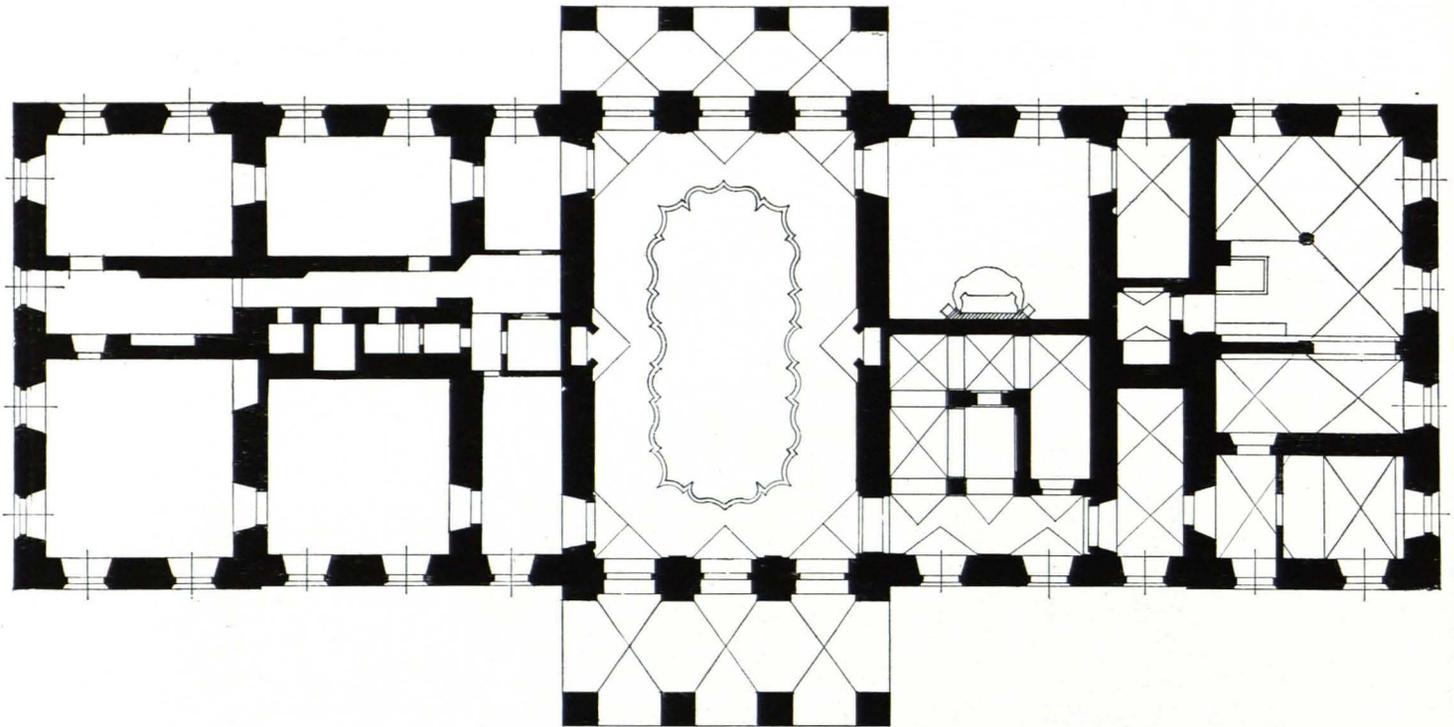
Leopoldskron. Grundriß im Erdgeschoß 1 : 300 (S. 308)
